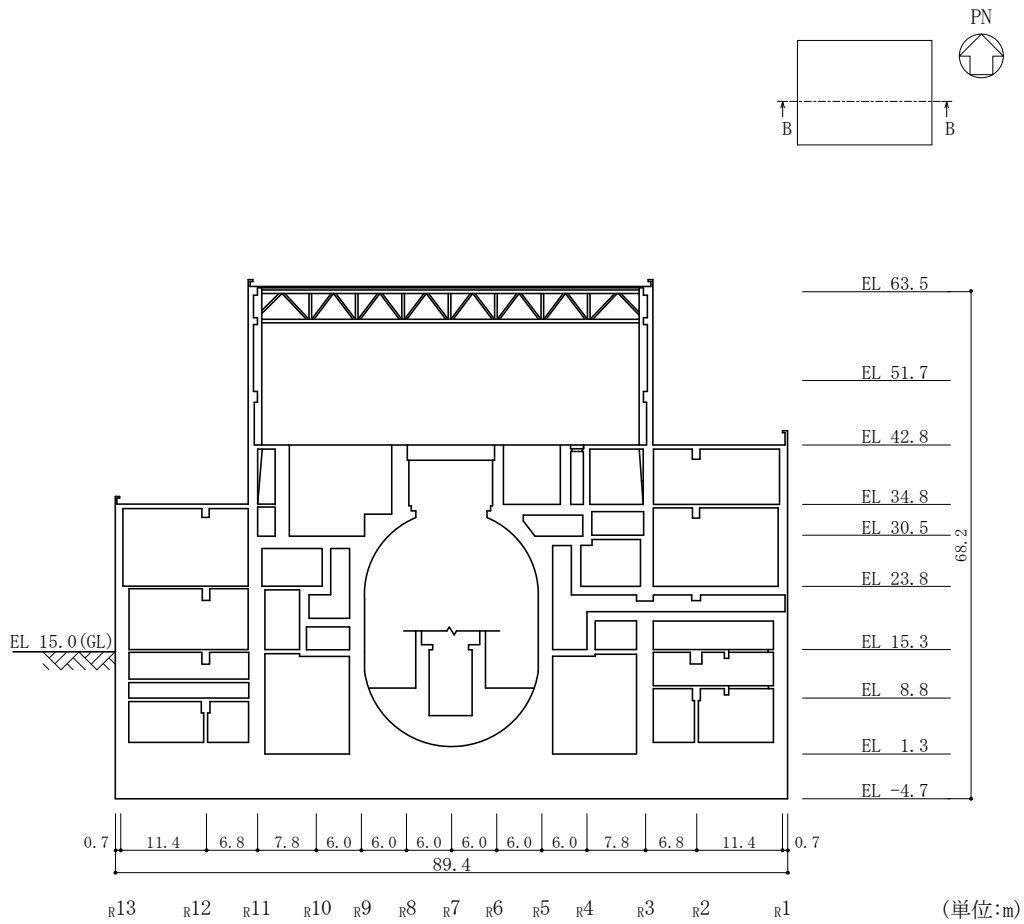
(2) 原子炉建物の概略断面図 (B-B断面, EW方向)
